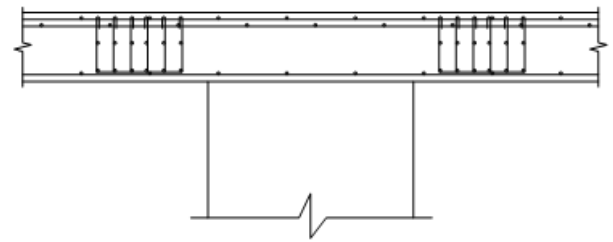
Установка поперечной арматуры в зоне продавливания
